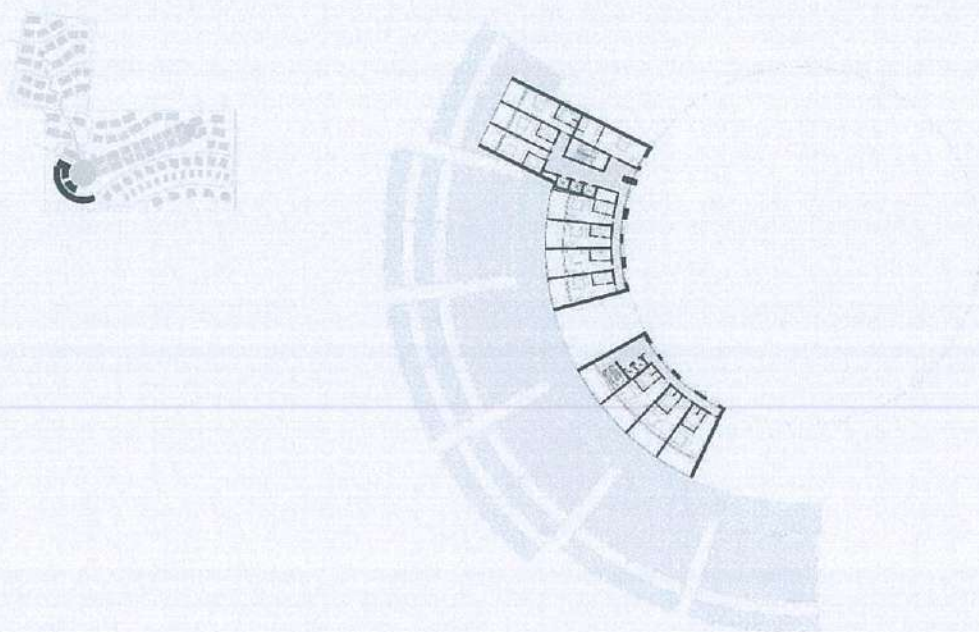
Sun Piazza Hotel: Plani i katit të dhomave.
